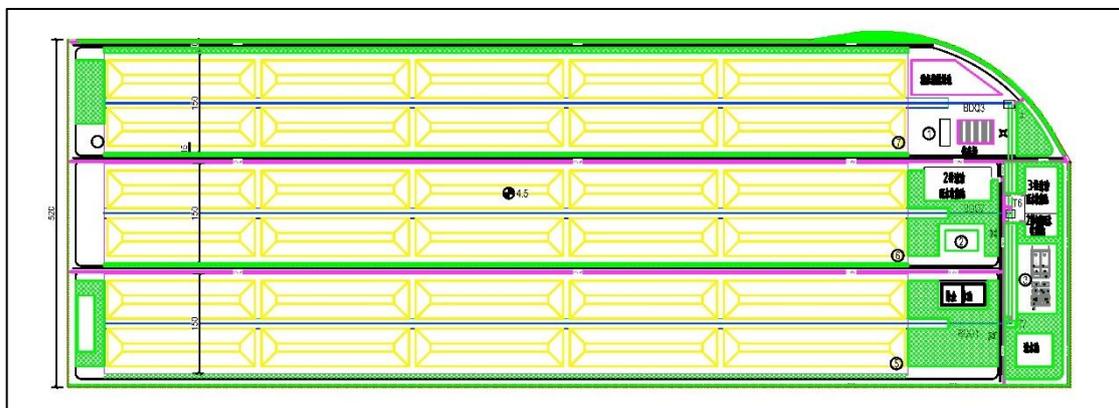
(2) 绿化平面布置图 (堆场区)
